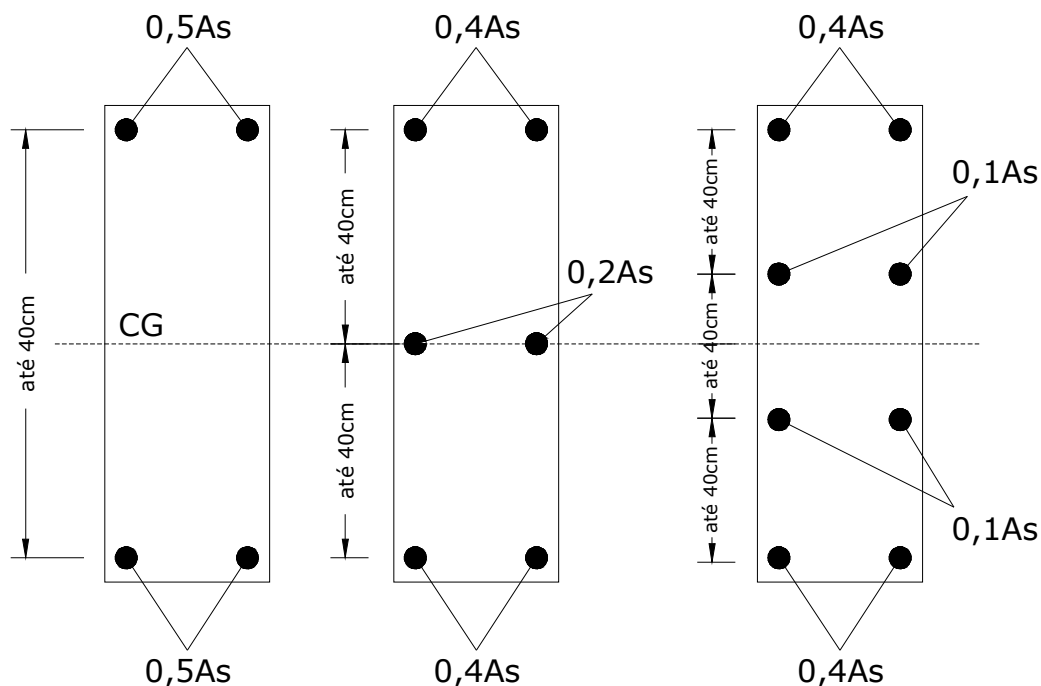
Configurações possíveis de armadura para elementos verticais ou inclinados
